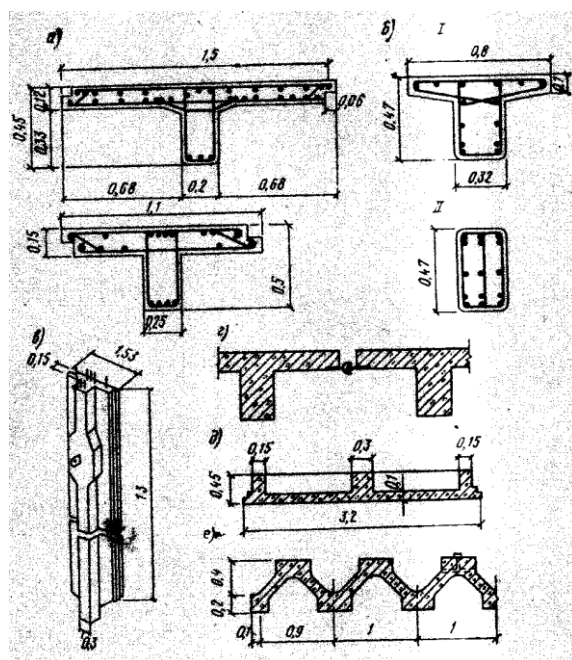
Железобетонные шпунты таврового и фигурного профиля: а – тавровый шпунт; б – тавровый шпунт с полкой не по всей длине: I – выше дна; II – ниже дна; в – тавровый шпунт с предварительно напряженной арматурой; г – тавровый шпунт со стальными замками; д, е – широкопанельные шпунты.
